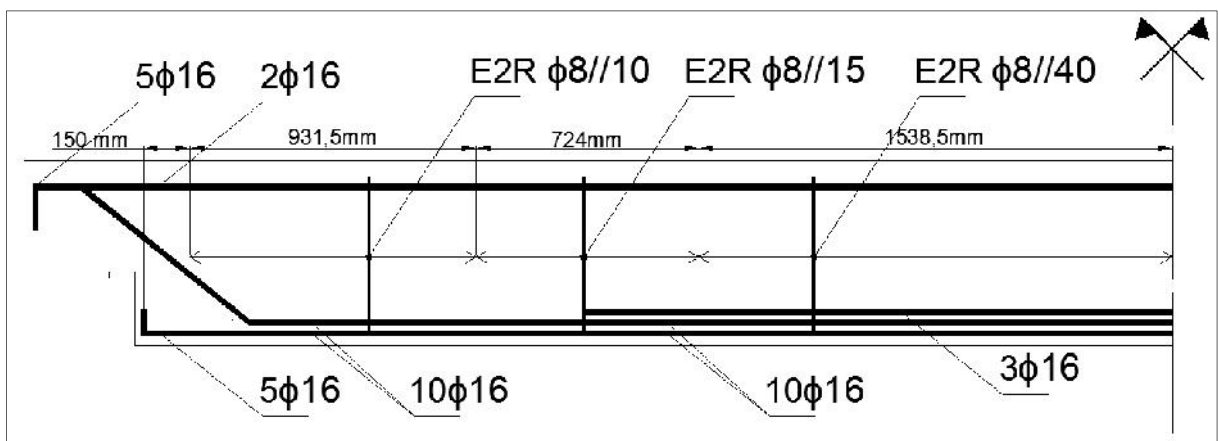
Esquema de armaduras provenientes apenas do cálculo do MET.
